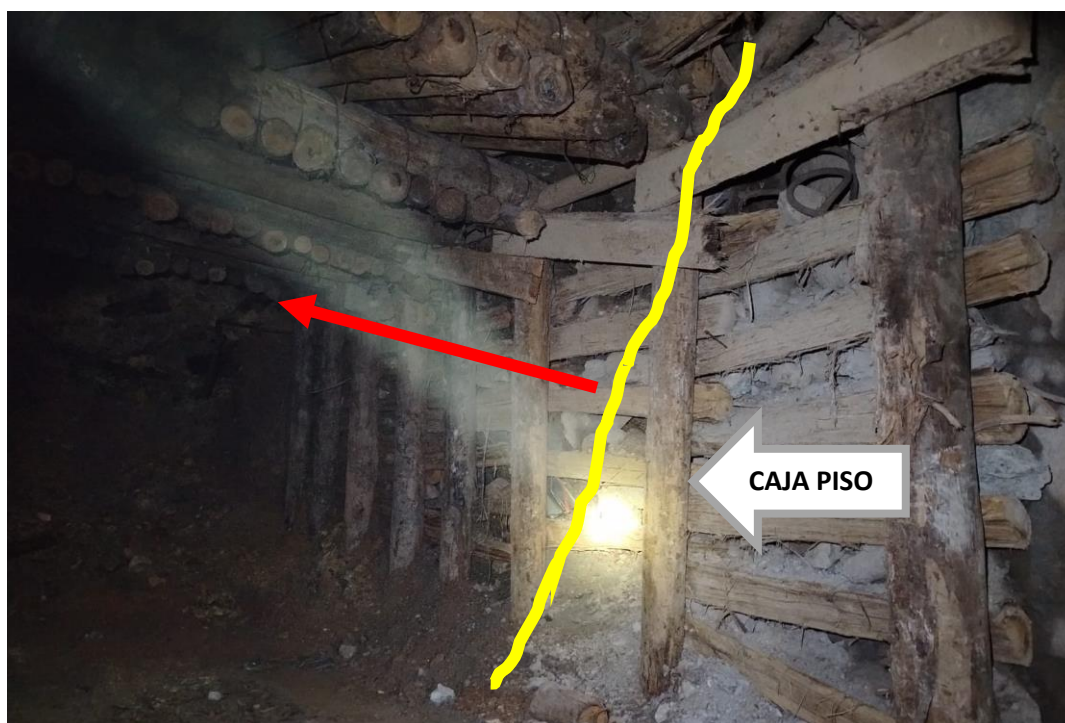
Armado de cuadro en toda la estructura mineralizada.
